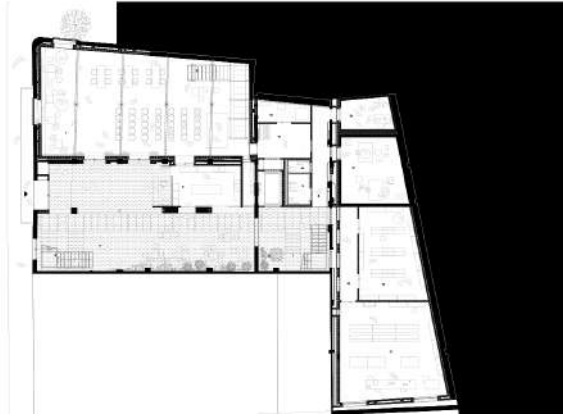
Planta do Centro Civic dos HARQUITECTES.
